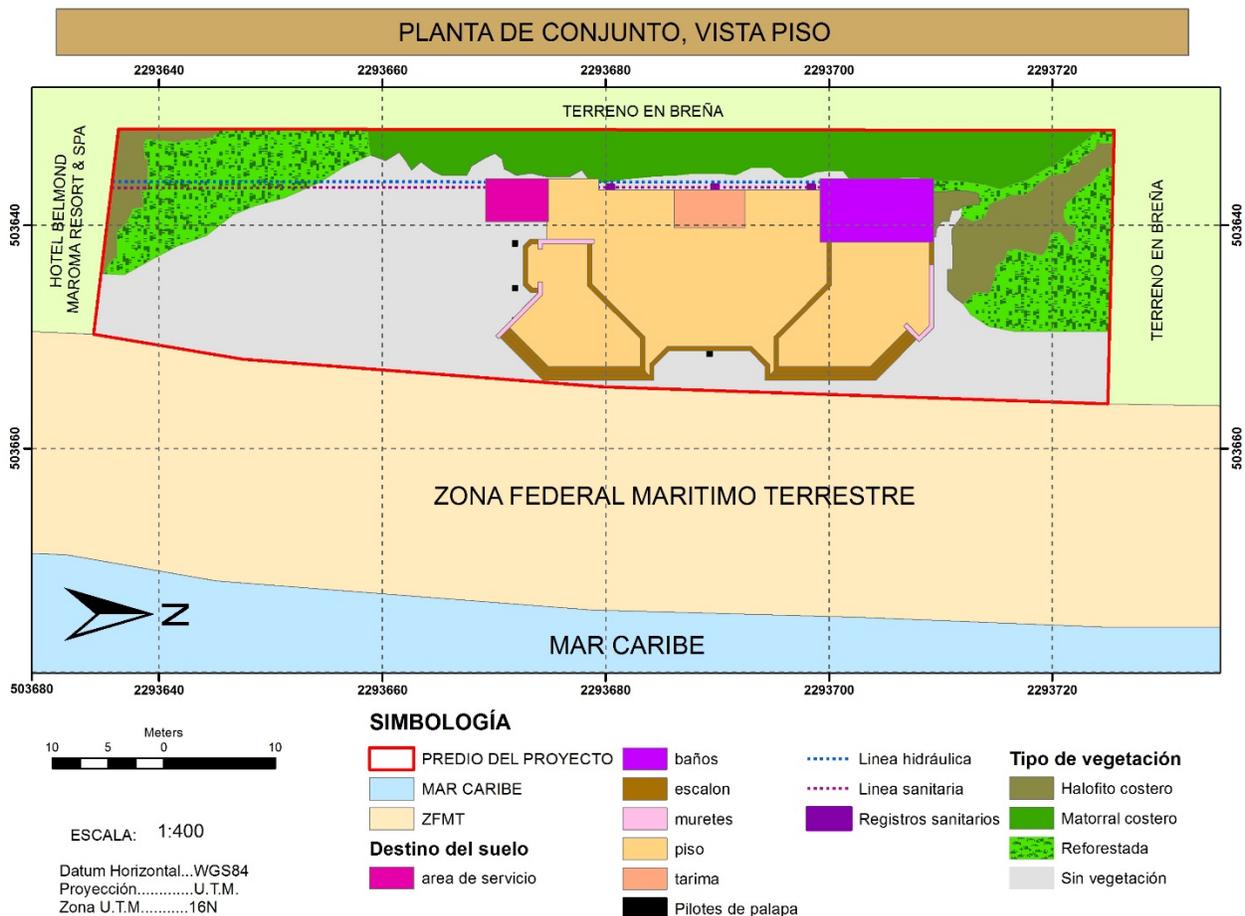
Planta conjunta del proyecto terminado. Se observa la distribución de las áreas internas de la palapa proyectada y las áreas verdes al nivel del terreno. Se proyectan también las líneas hidráulica y sanitaria. Fuente: Promotora.
